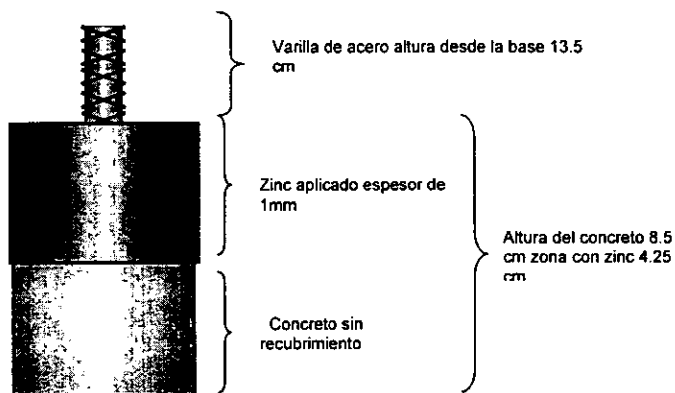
Representación de la probeta de concreto con zinc aplicado sobre la mitad de esta.
